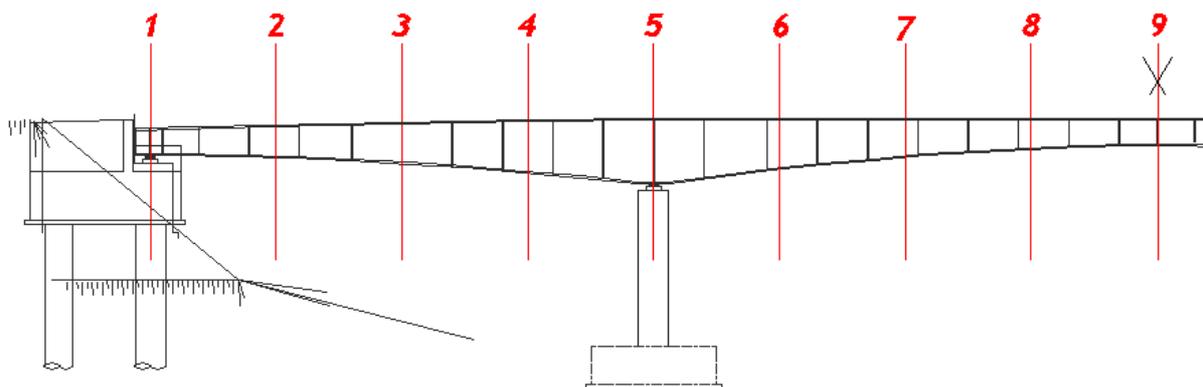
PROSPETTO DEL PONTE CON EVIDENZIATE LE SEZIONI DI ANALISI
